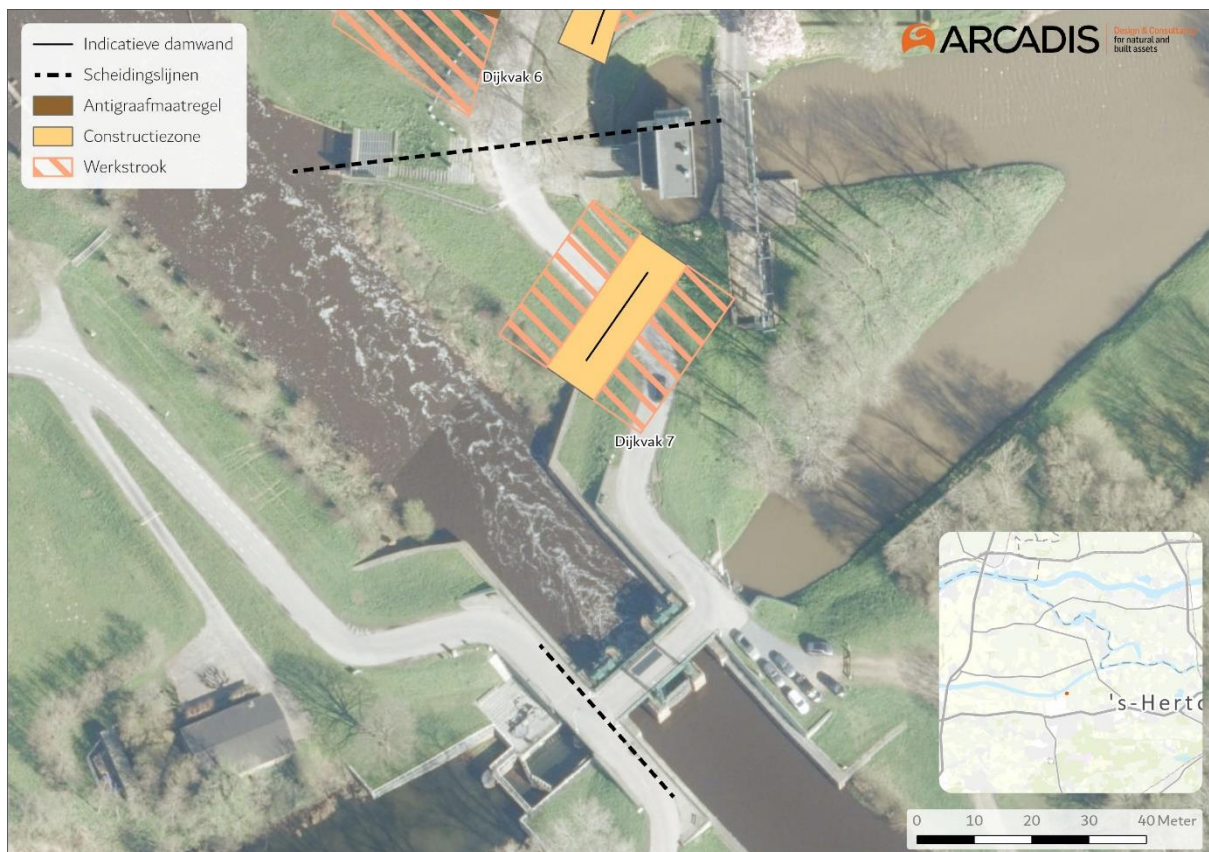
Heavescherm, constructiezone, werkstrook en overige werkzaamheden dijkvak 6
